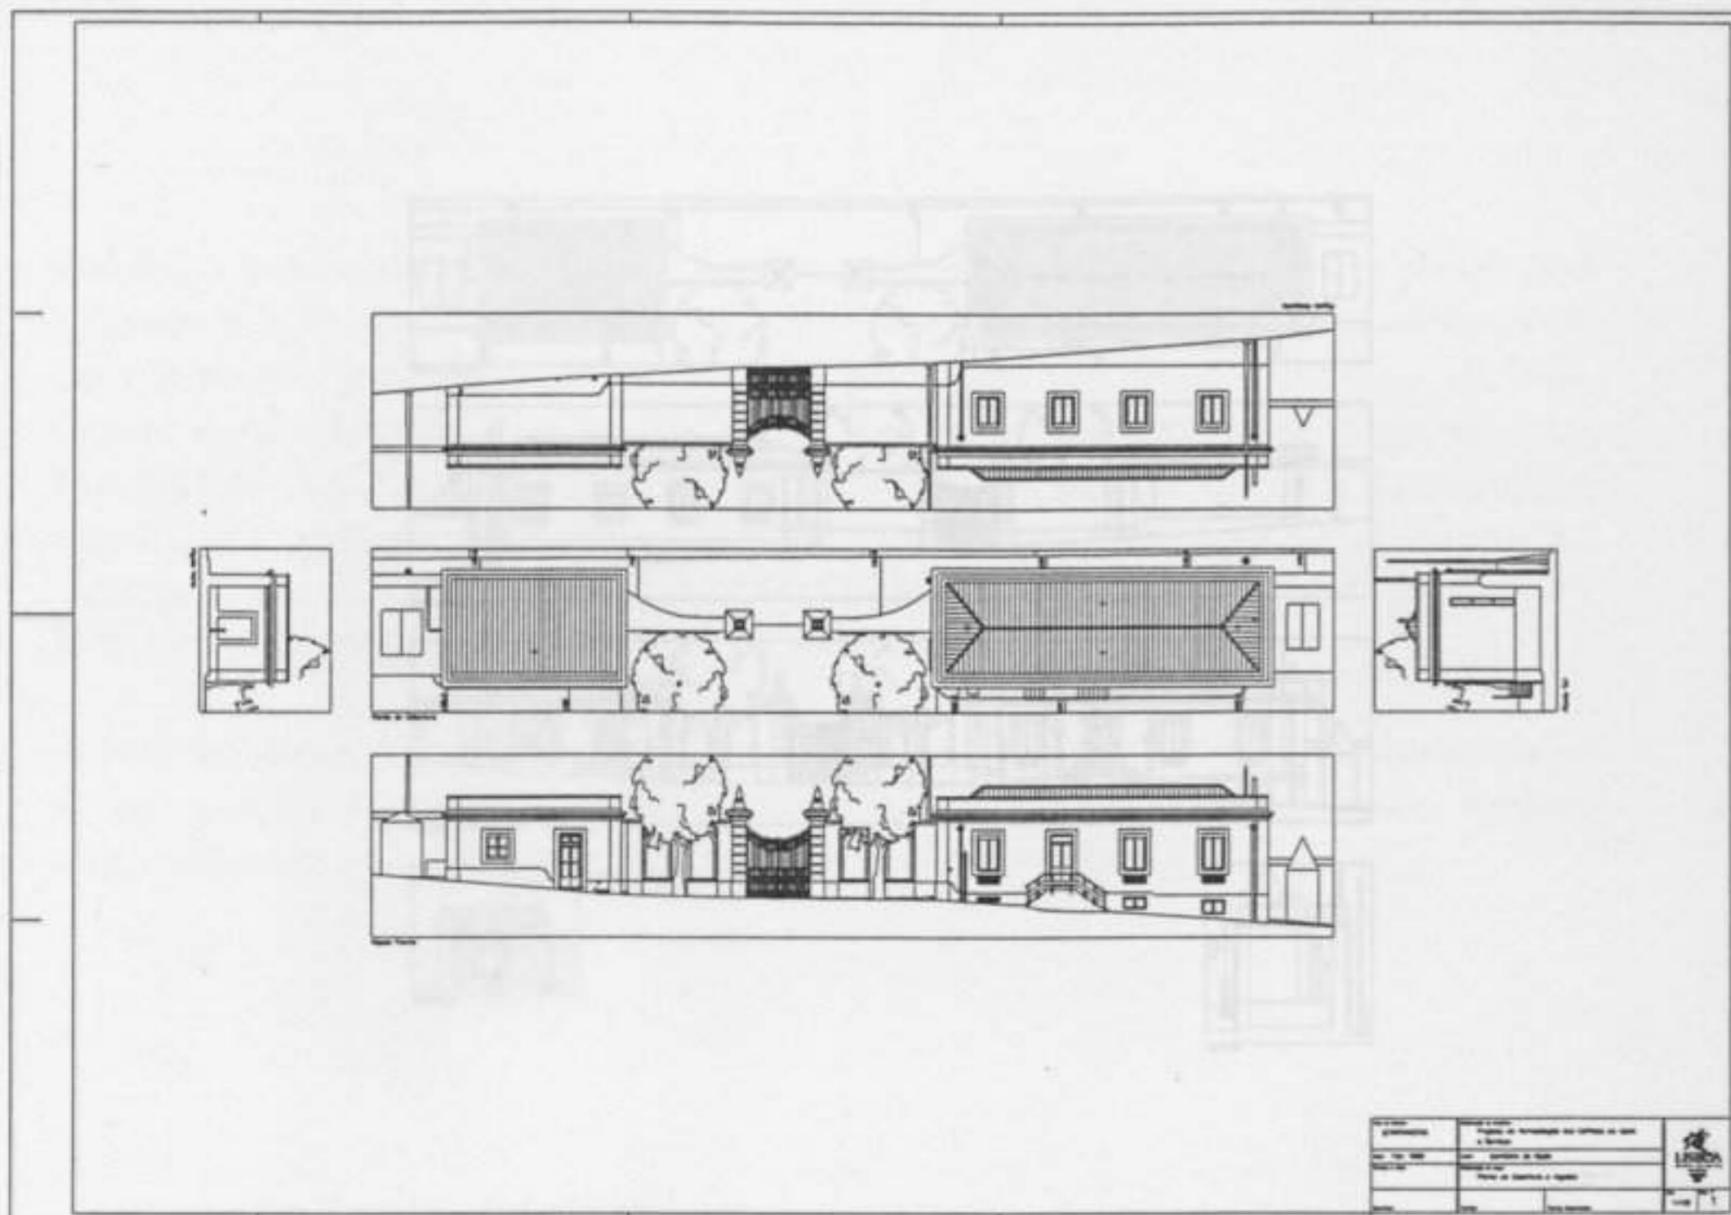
Levantamento - Planta de Cobertura e Alçados - Esc. 1/100 - Des. nº 1.
